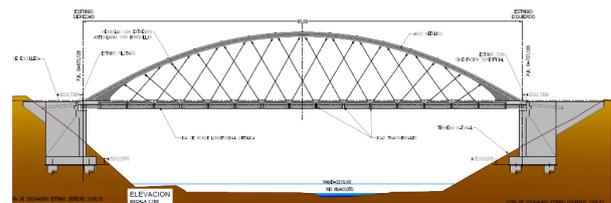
Alzado tipo de puente de 65 m (Cachimayo)
